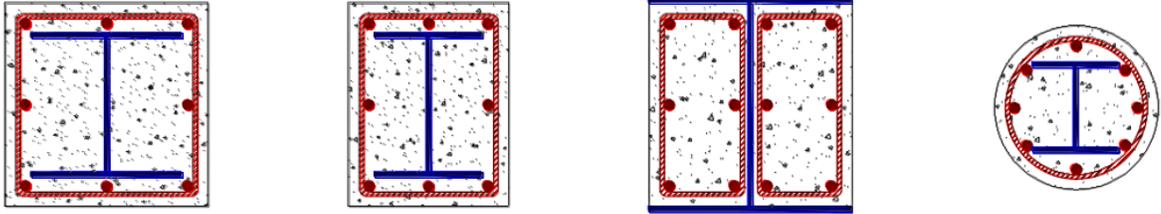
Columnas con perfiles de acero embebidas en hormigón
